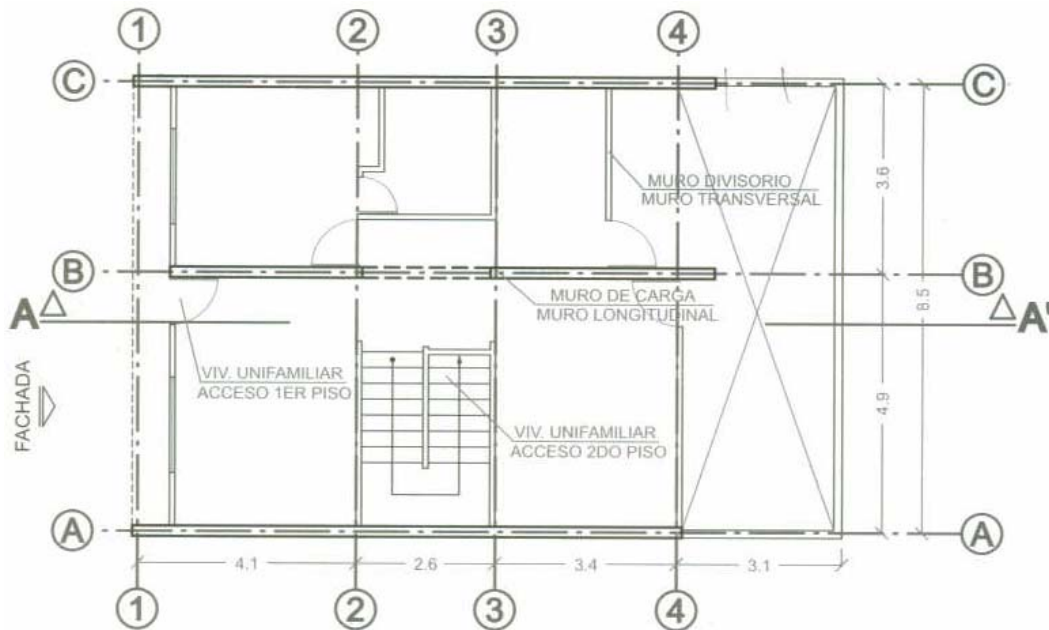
Planta de distribución de muros del primer piso, casa zona 11
